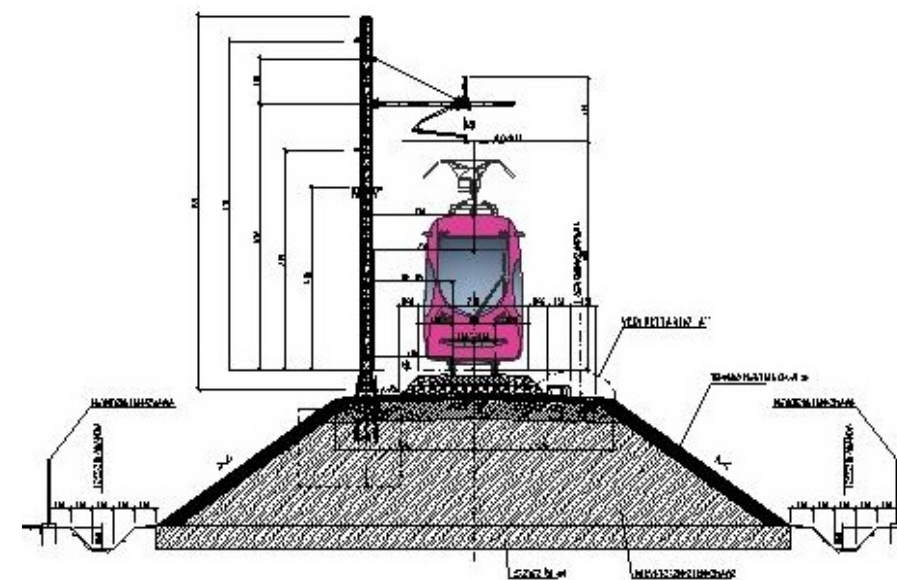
Tracciato ferroviario - Sezione tipo in rilevato
